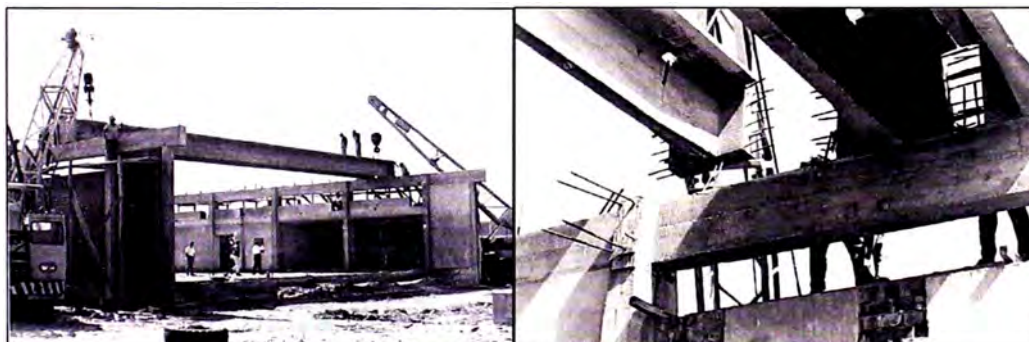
3 .-Montaje de las vigas prefabricadas de concreto postensado
